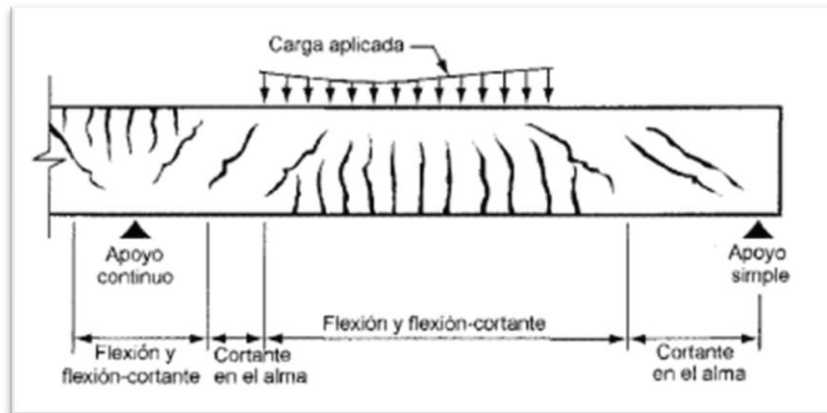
Tipos de agrietamiento en vigas de concreto [2]
